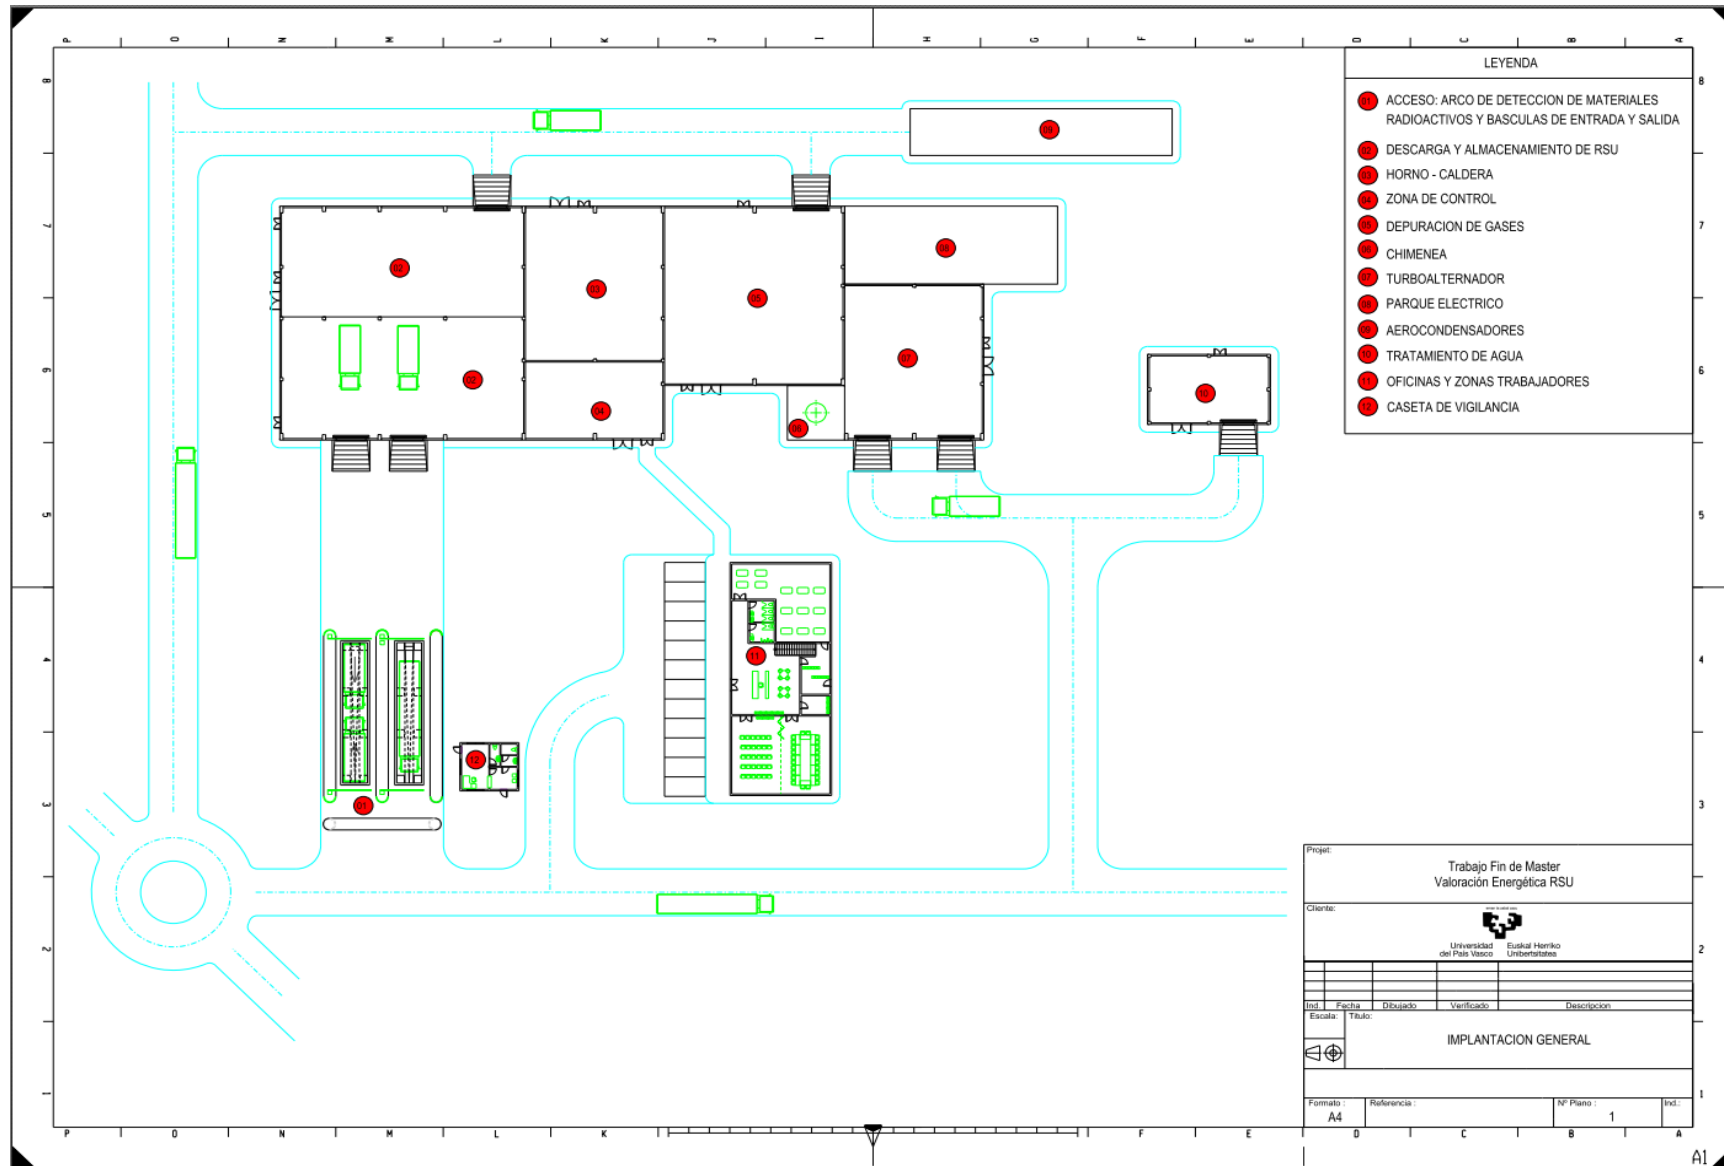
Plano de implantación general de la planta (elaboración propia)
